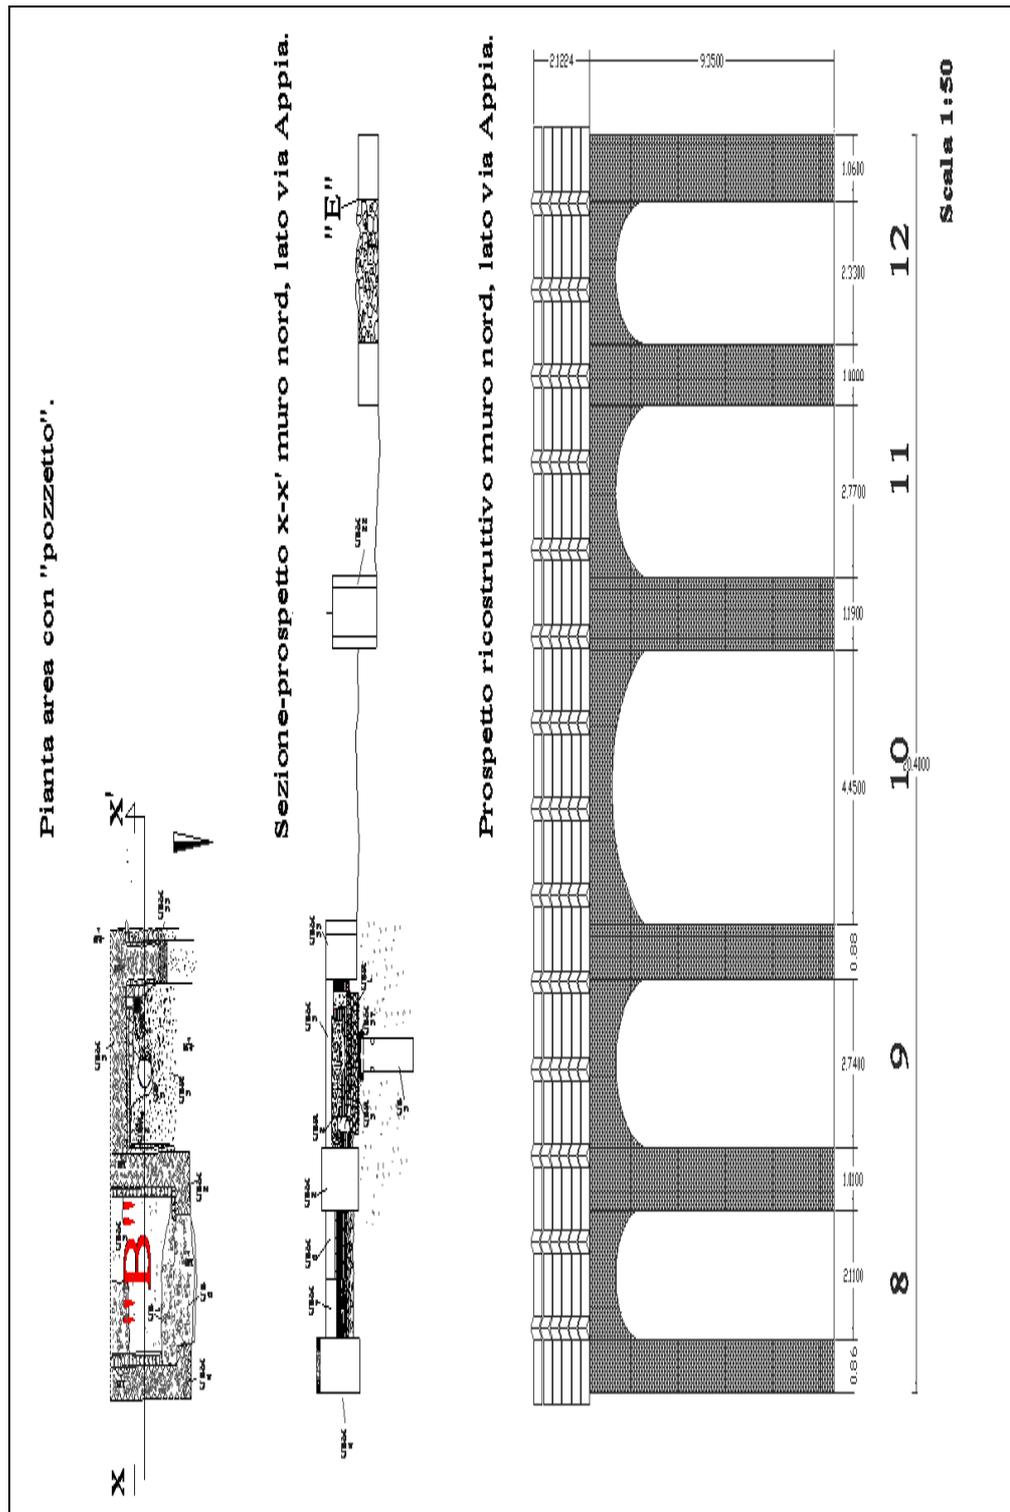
Pianta, prospetto-sezione ed ipotesi ricostruttiva muro perimetrale nord, lato via Appia (secondo l'ipotesi A).
